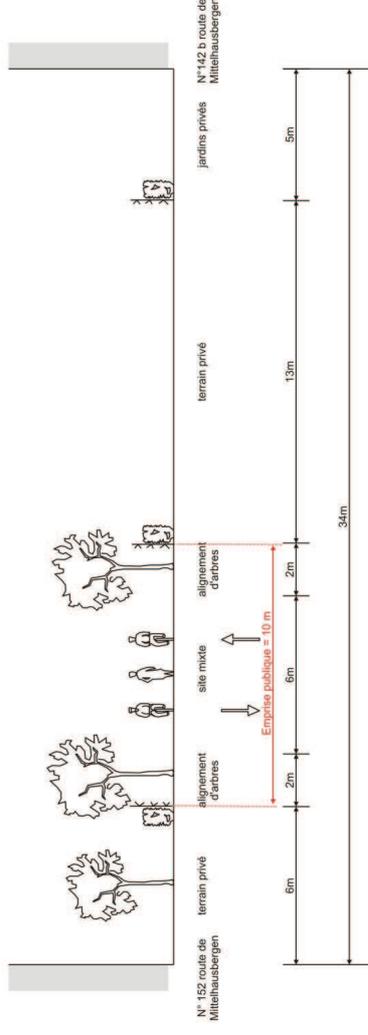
Situation existante coupe 7 Parc de la Bergerie
